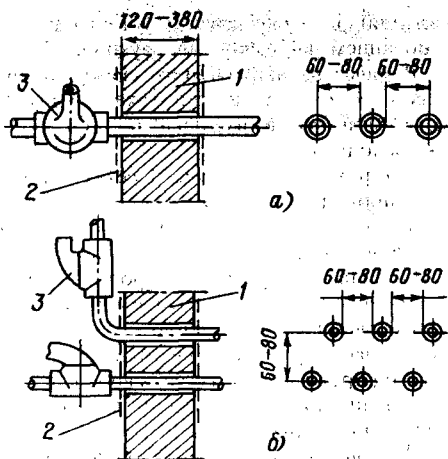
Проходы трубопроводов из взрывоопасной зоны в невзрывоопасную или в помещение со взрывоопасной зоной другого класса либо с другой категорией или группой взрывоопасной смеси:
